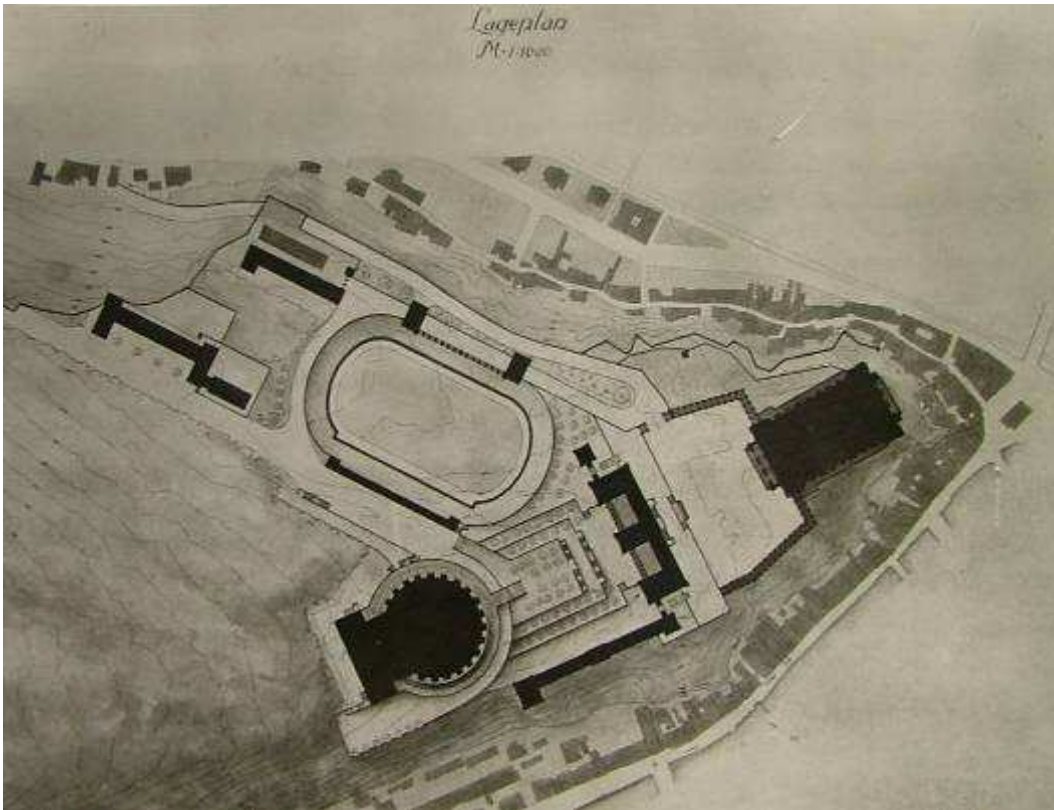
Lageplan, Imbergverbauung, Salzburg, erste Projektphase, Variante A, November 1940 (HSS, INR 004.564).
